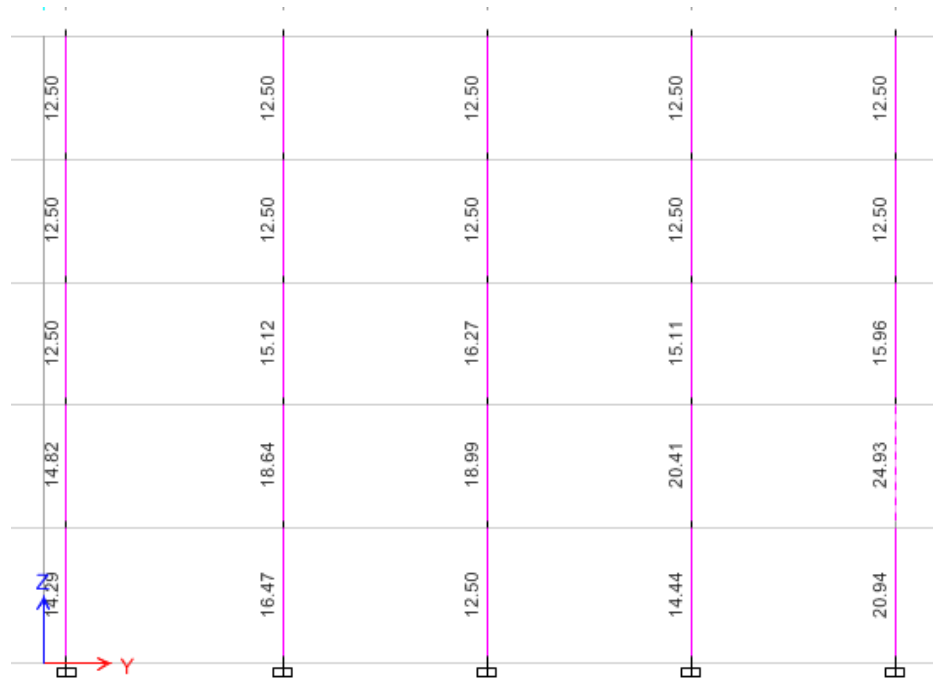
Cantidad de acero en cm^2 en columna 25x50 eje C.
